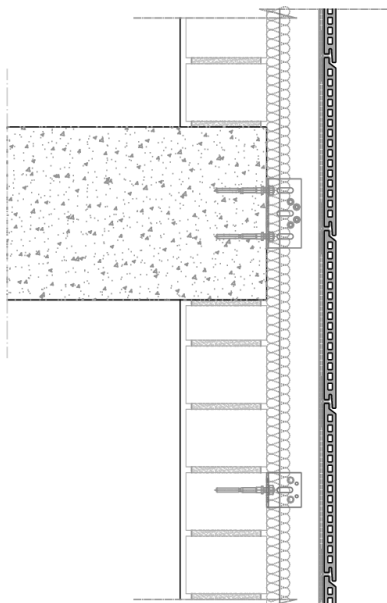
Sección vertical. Faveton® SAH Ceram 20.
